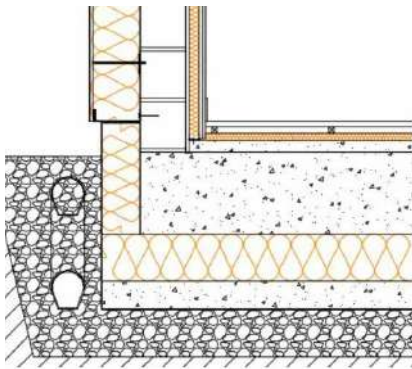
Detalle losa de cimentación de la casa la Perihonda, certificación Passivhaus, Proyecto 5 diciembre, 2016. Fuente: Passivhauspasopaso.
